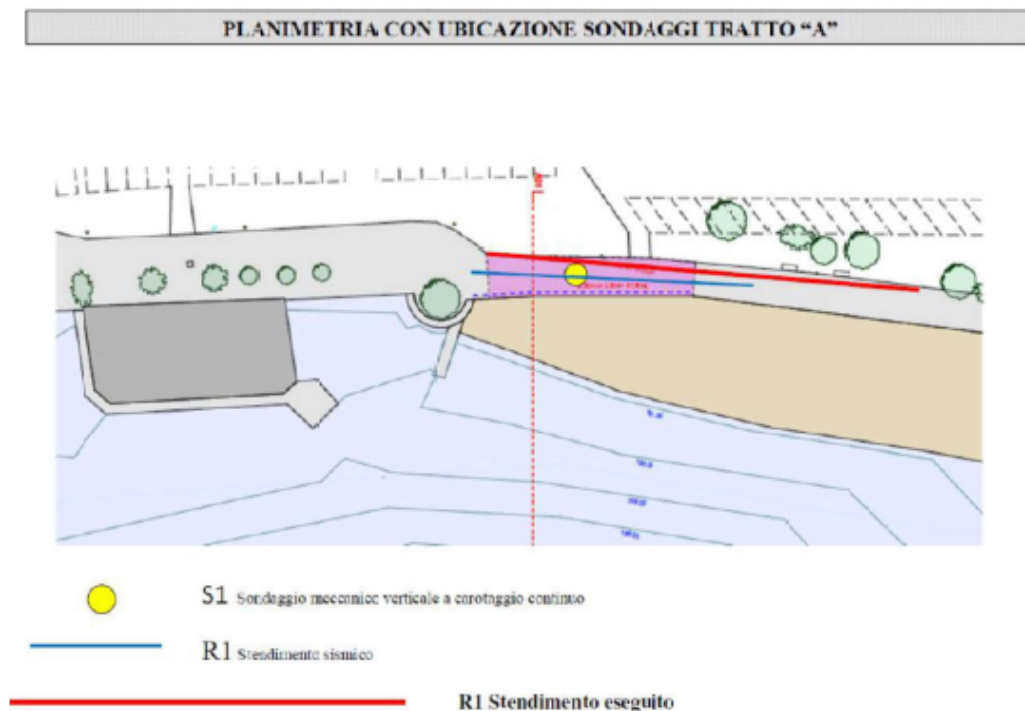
Consolidamenti lungolago di Pallanza, tratto A.- Sondaggio S1
